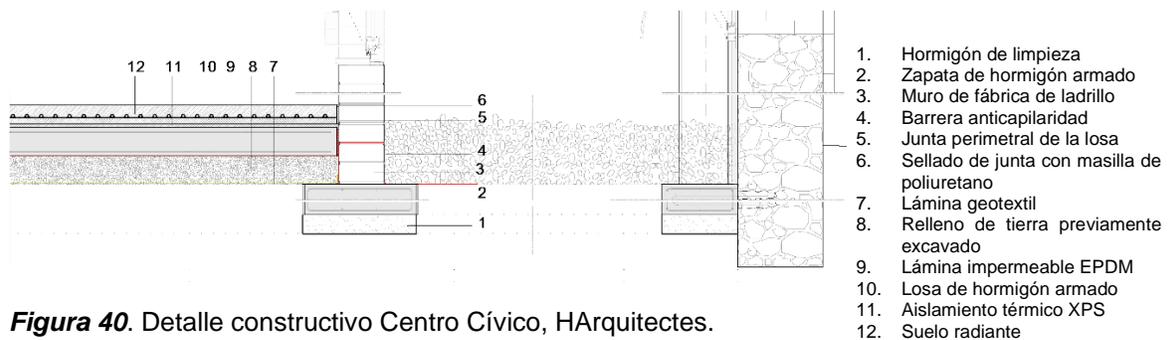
Detalle constructivo Centro Cívico, HARquitectes.
